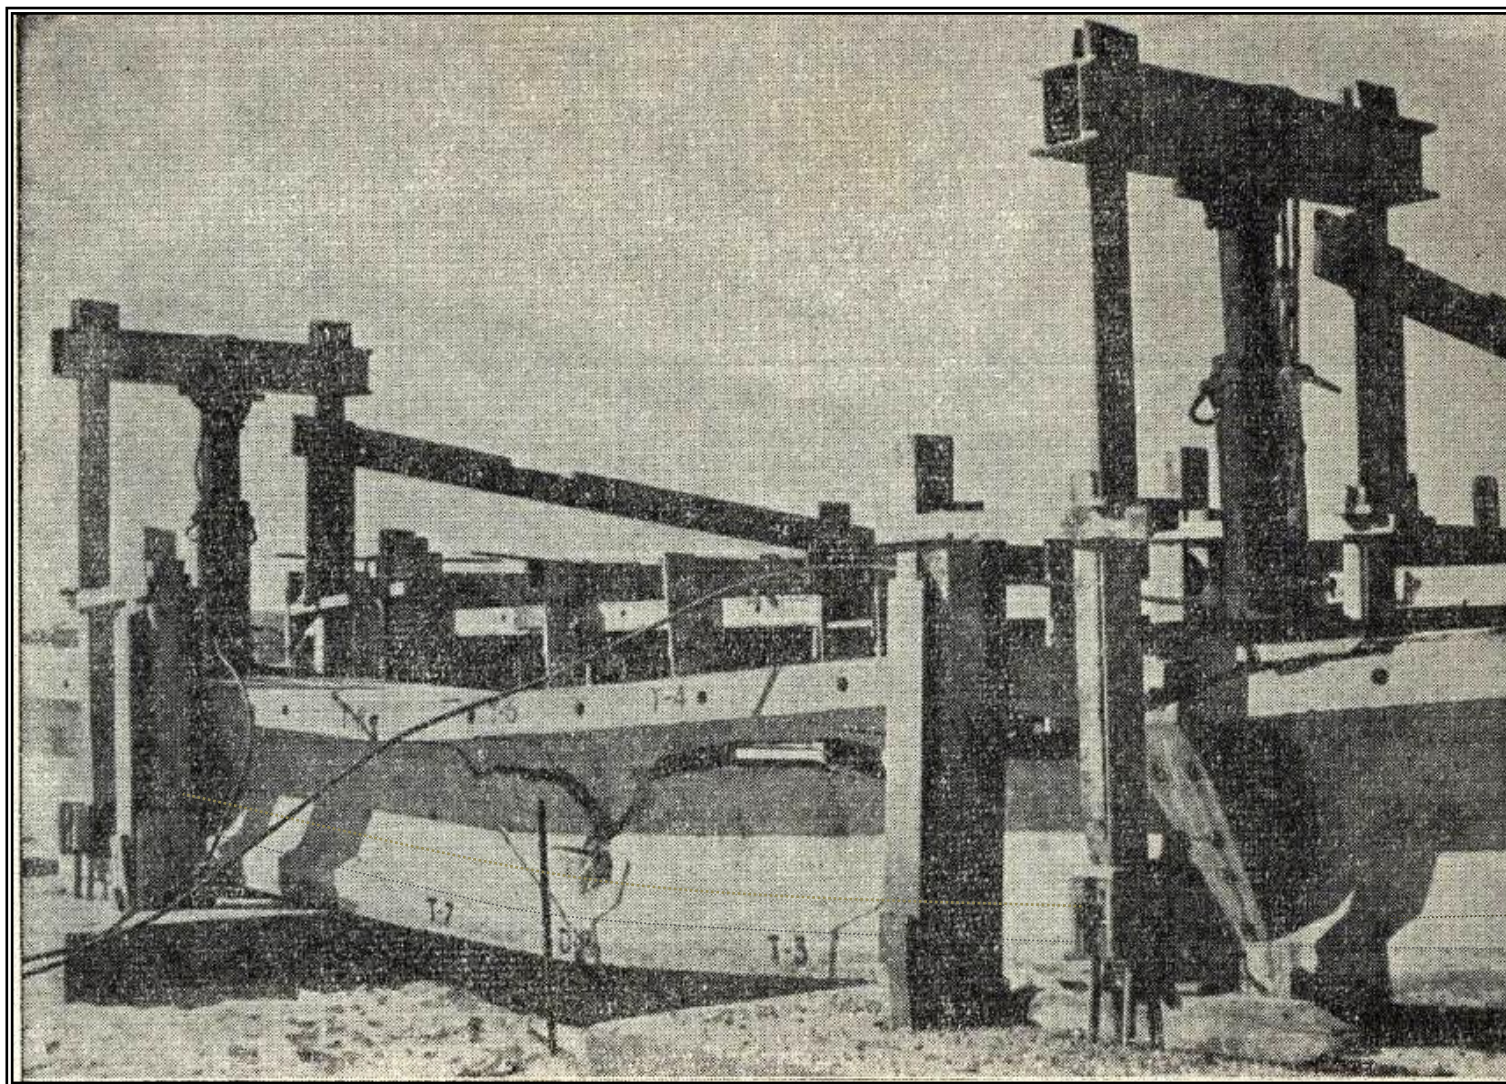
Ampliada : Fissuração concentrada em uma grande fissura central.
